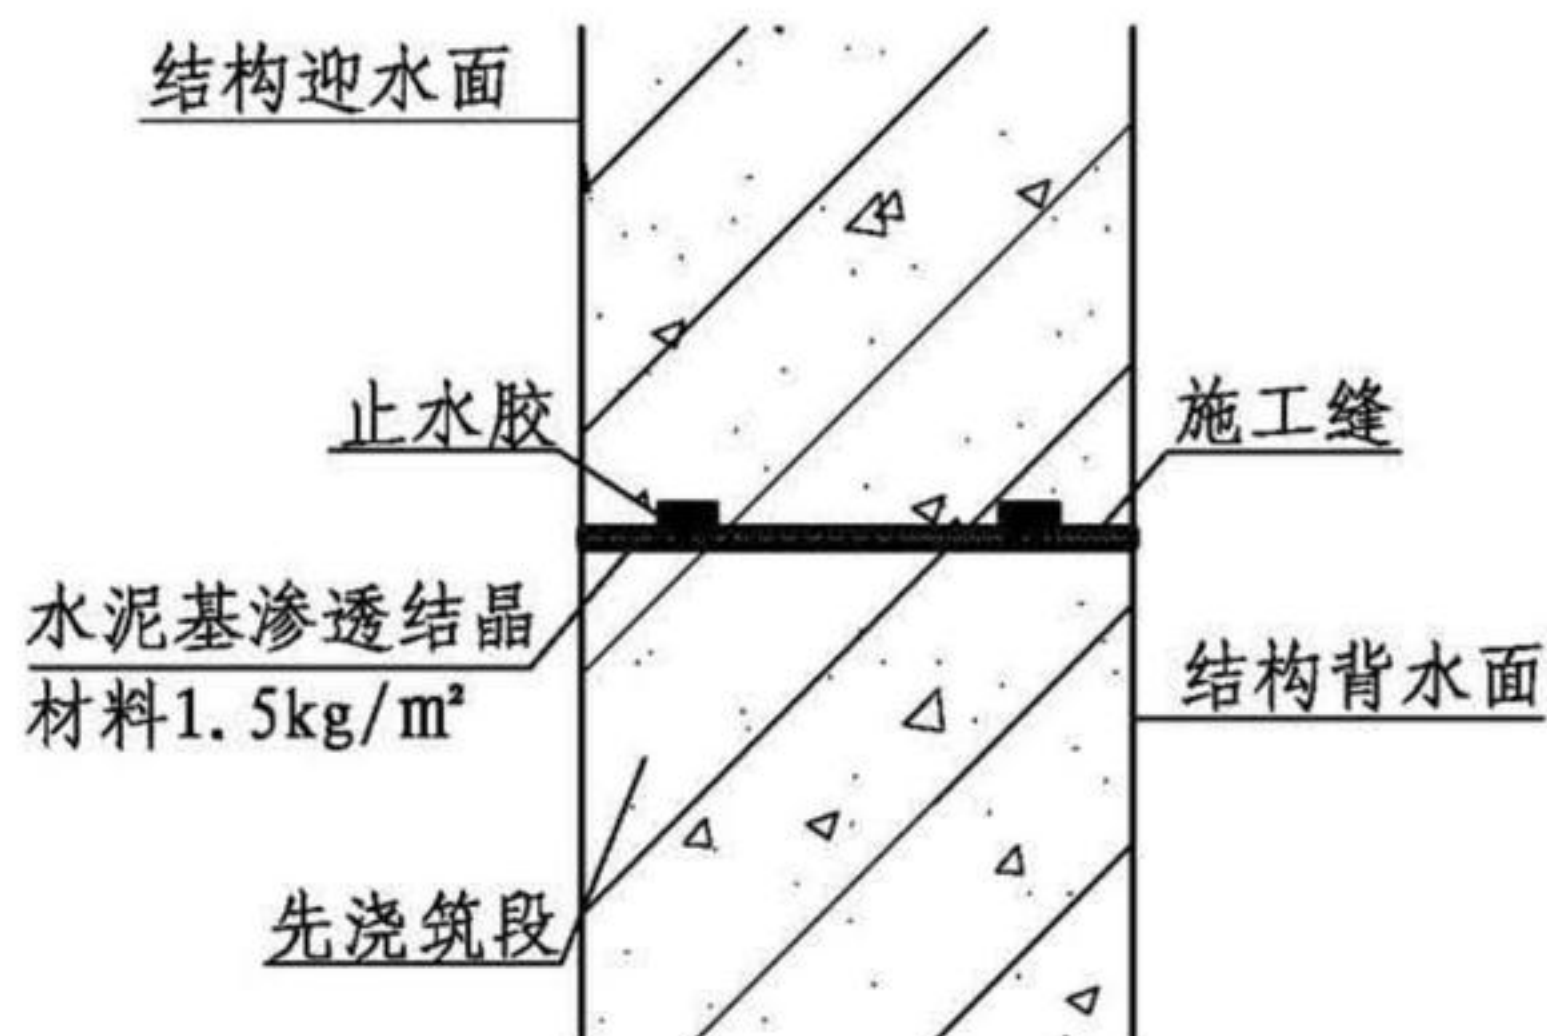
侧墙（纵向）施工缝防水构造示意图（一）
